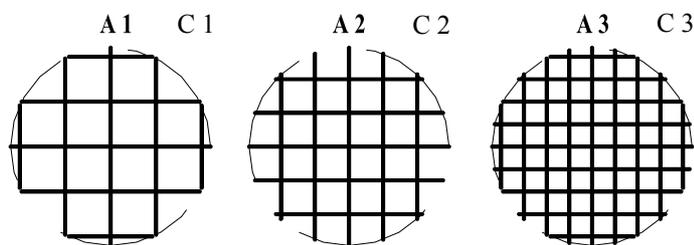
Арматурные сетки для поверхностного армирования грунта:
